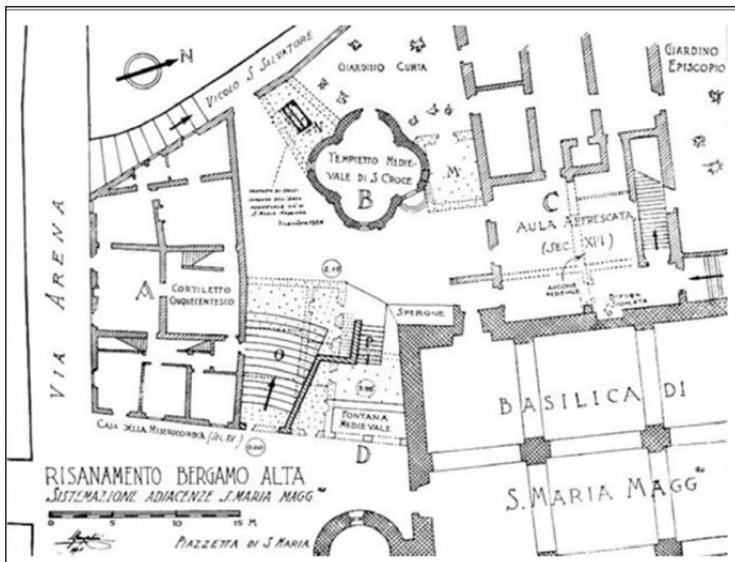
Planimetria intervento di abbattimento della casa del sagrista
